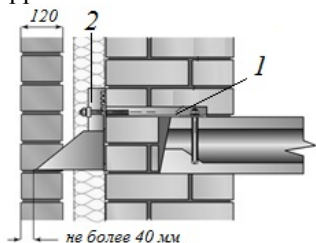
Система анкерного крепления лицевой кладки: 1 – анкер; 2 – консольный кронштейн.
